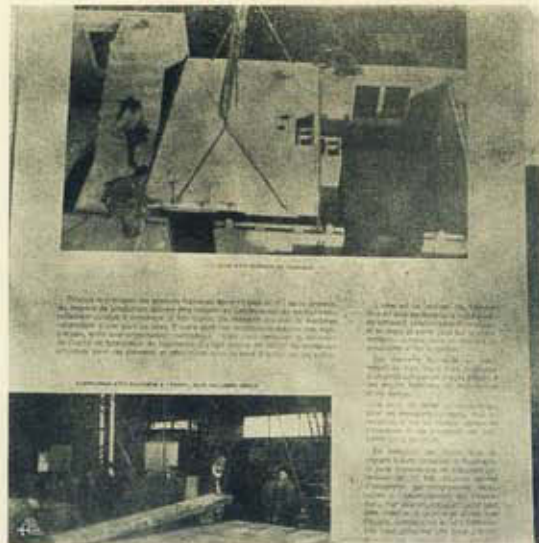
Em cima: a colocação de outro elemento de um piso-tecto.
